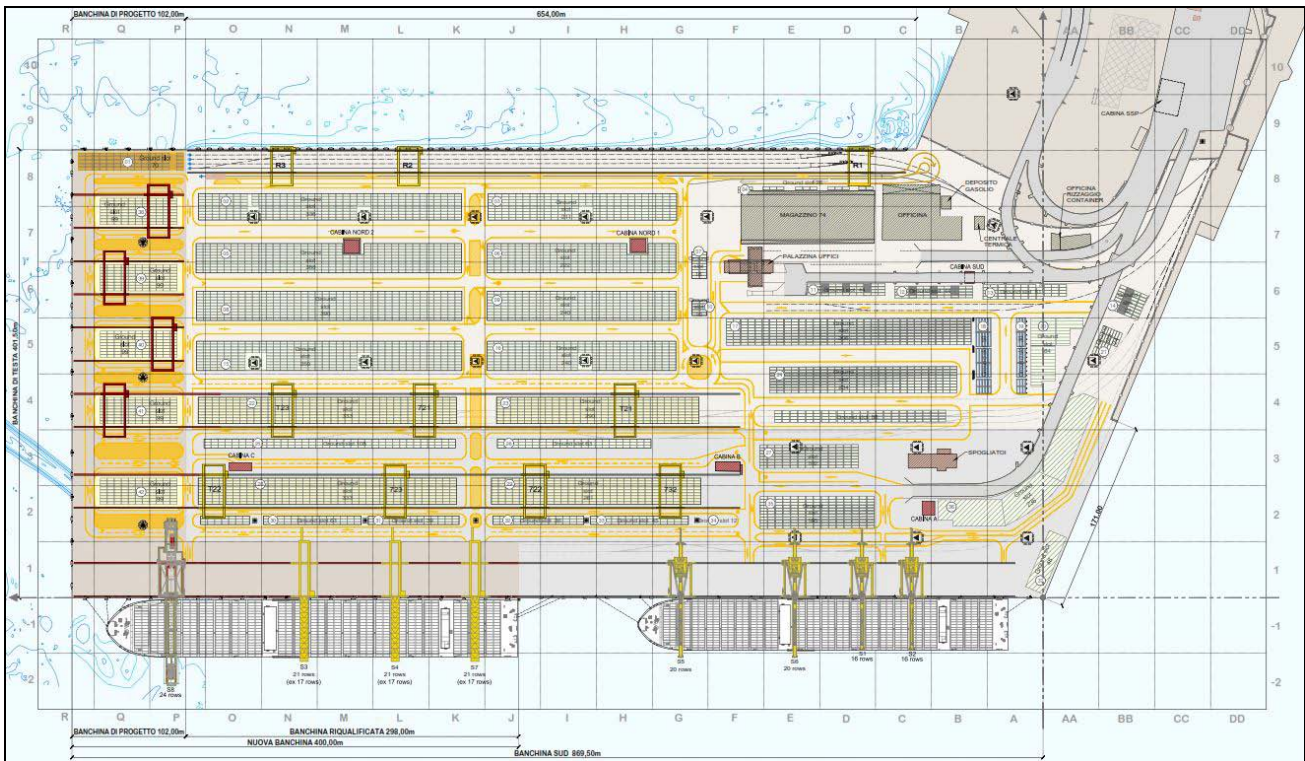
Planimetria di progetto – Layout funzionale del terminal
